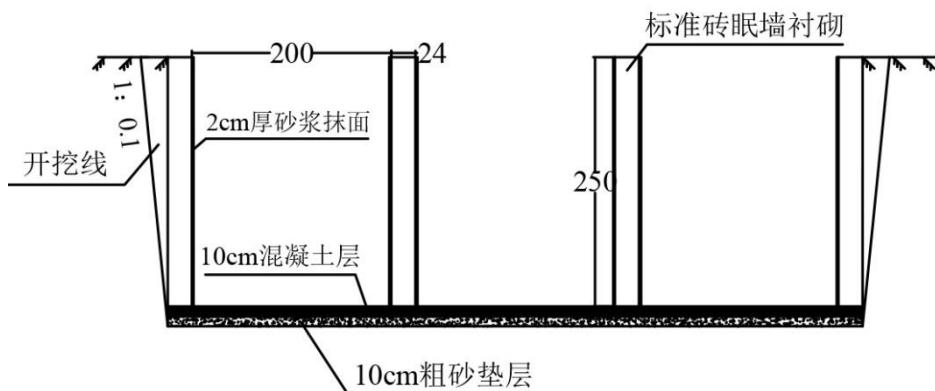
沉淀池设计剖面示意图 单位: cm
